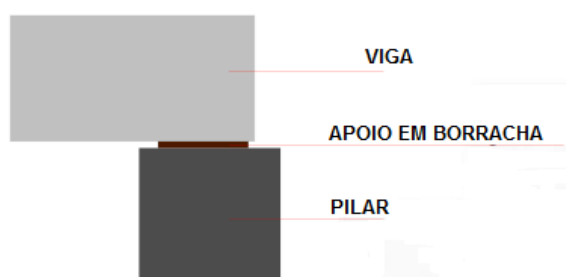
Exemplo de apoio simples entre viga e pilar
